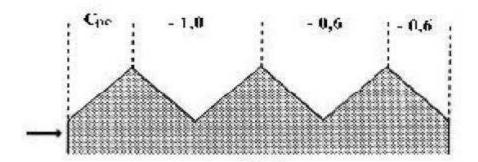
Coefficients de pressions extérieures Cpe de chaque versant de la toiture
